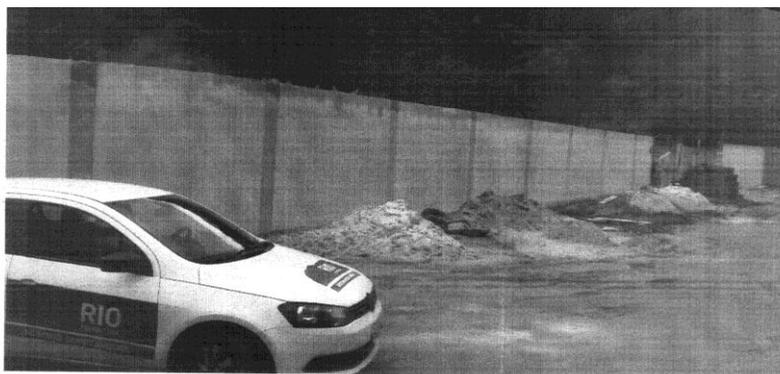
Muro construído na Est. da Itapuca no que poderia ser a testada do lote 3 do PAL 40075.
